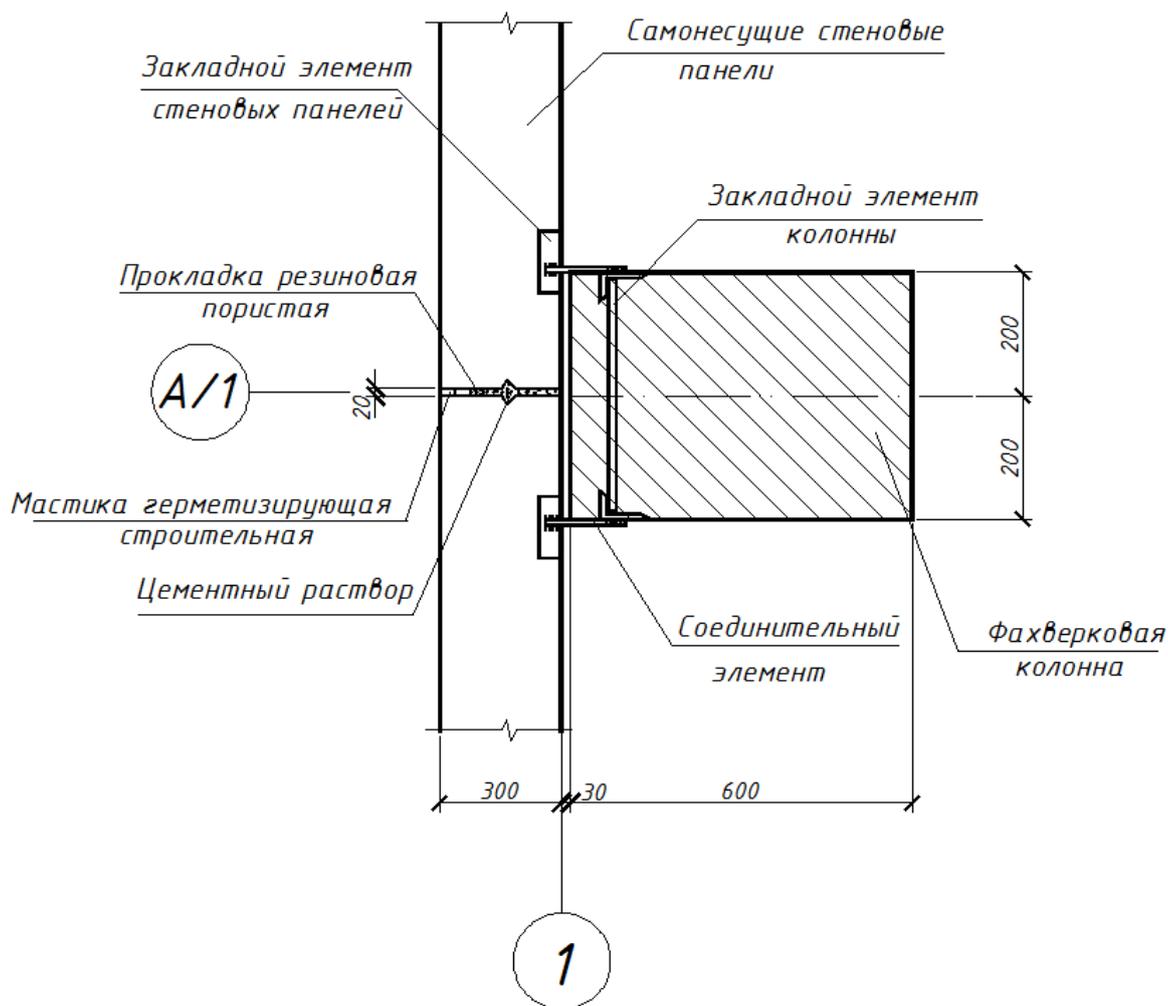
Узел сопряжения фахверковой колонны со стеновыми панелями (план)
